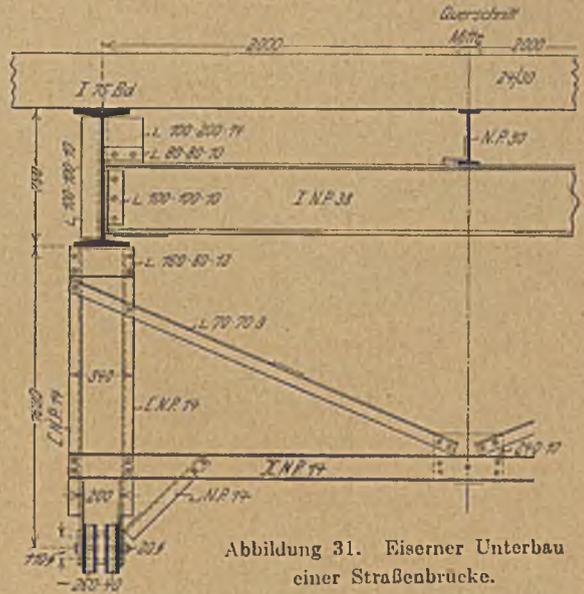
Eiserner Unterbau einer Straßenbrücke.
